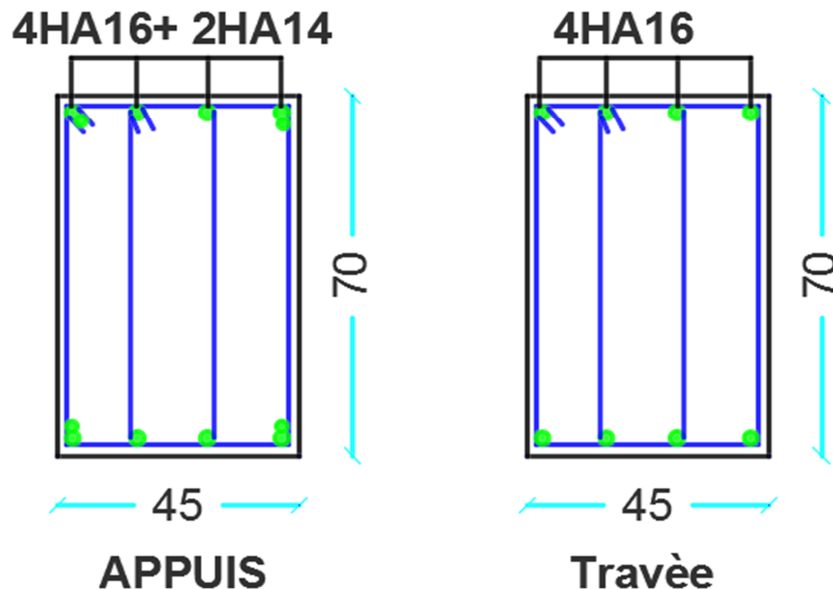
Schéma de Ferrailage la poutre de rigidité
